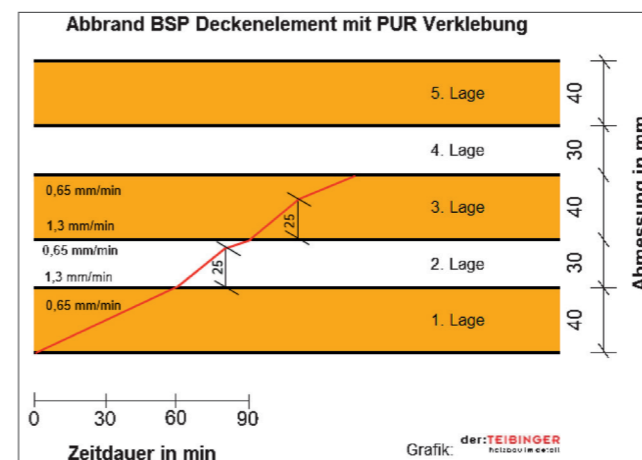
Verlauf des Abbrandes bei Brettsperrholzdecken mit PUR Verklebung
